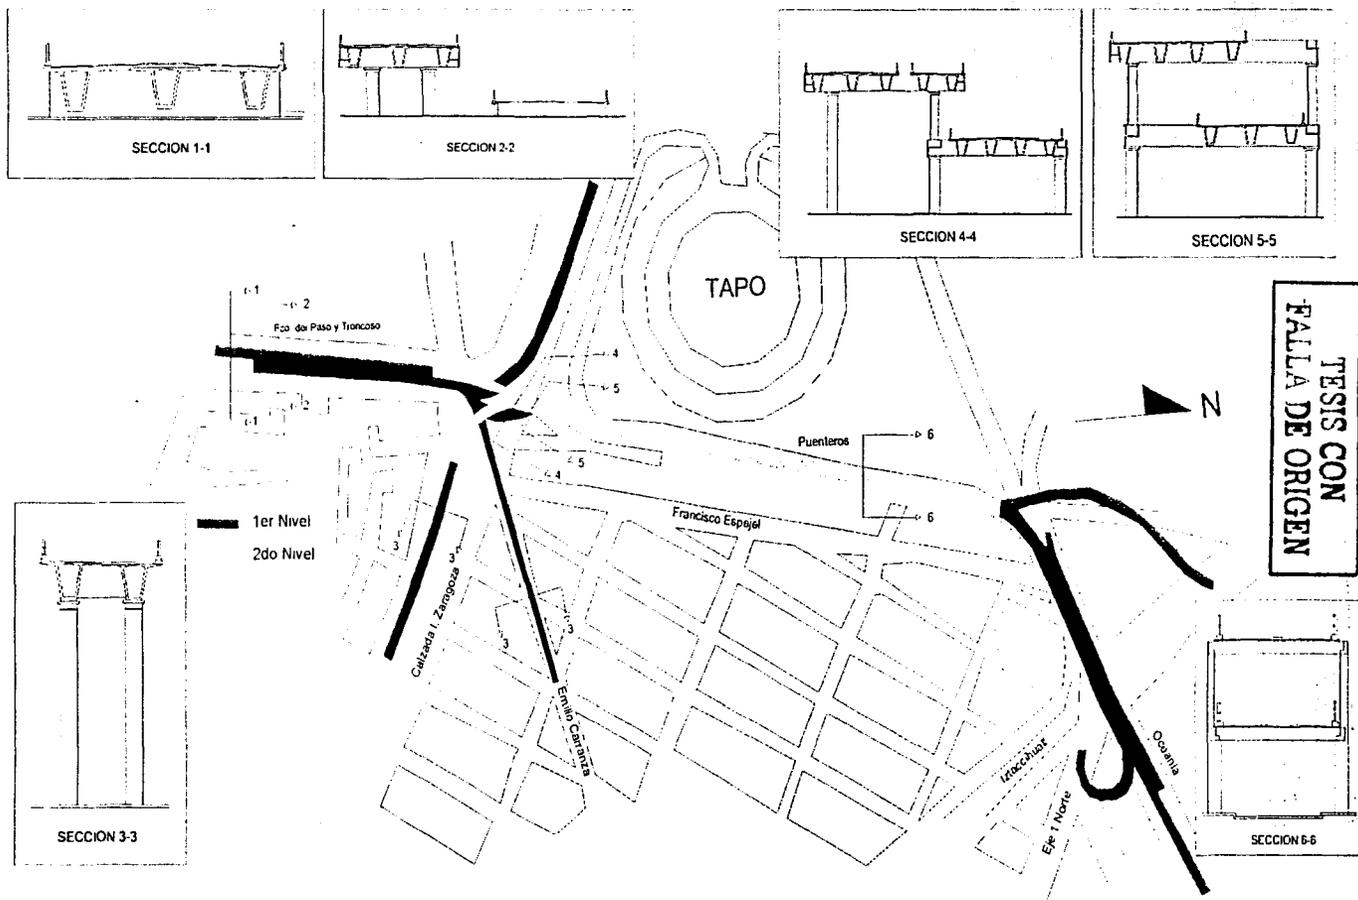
Planta General y Secciones a lo largo de la trayectoria
